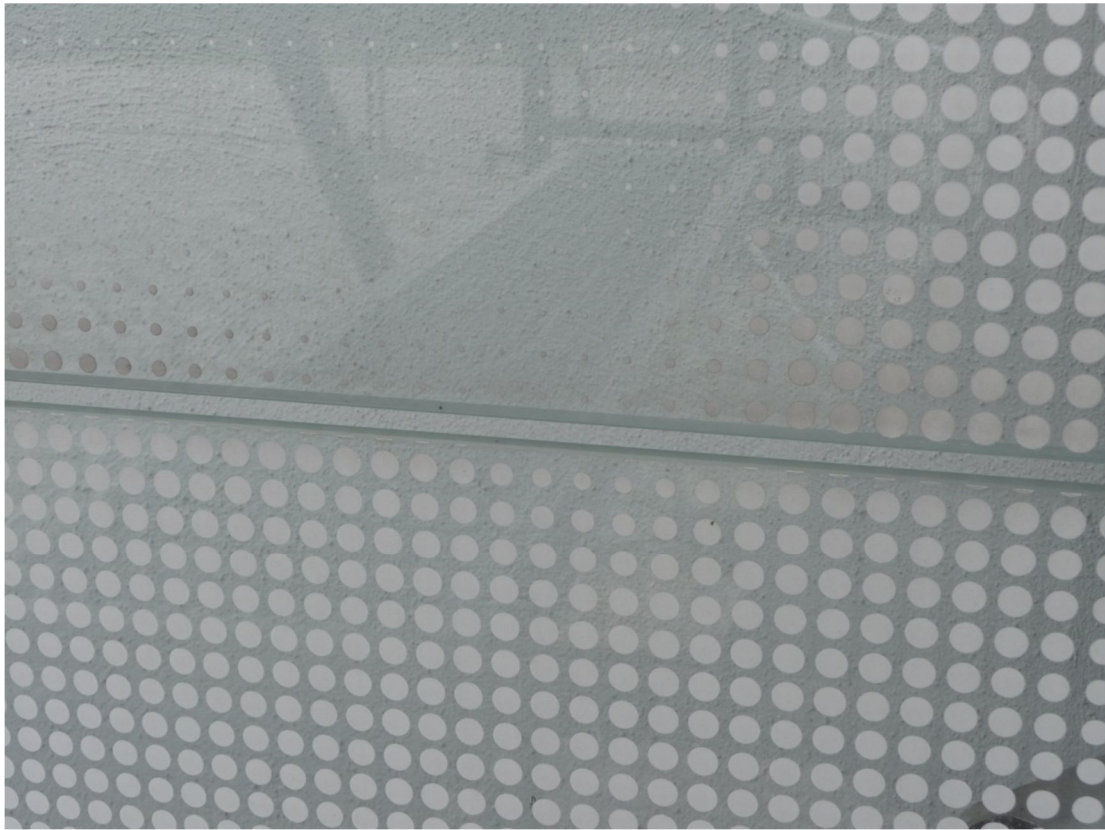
Detailansicht der Siebdruckpunkte auf der Fassade des IKMZ.
